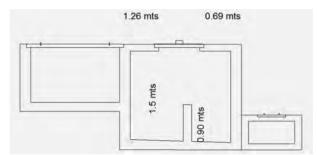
Vista perfil cámara tipo 1. Fuente: Diseño cámaras de quiebre por el Ing. Javier Leytón.
